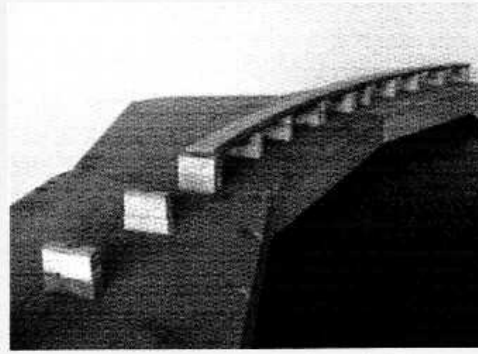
Przygotowana podpora o określonej wysokości (40 mm).
